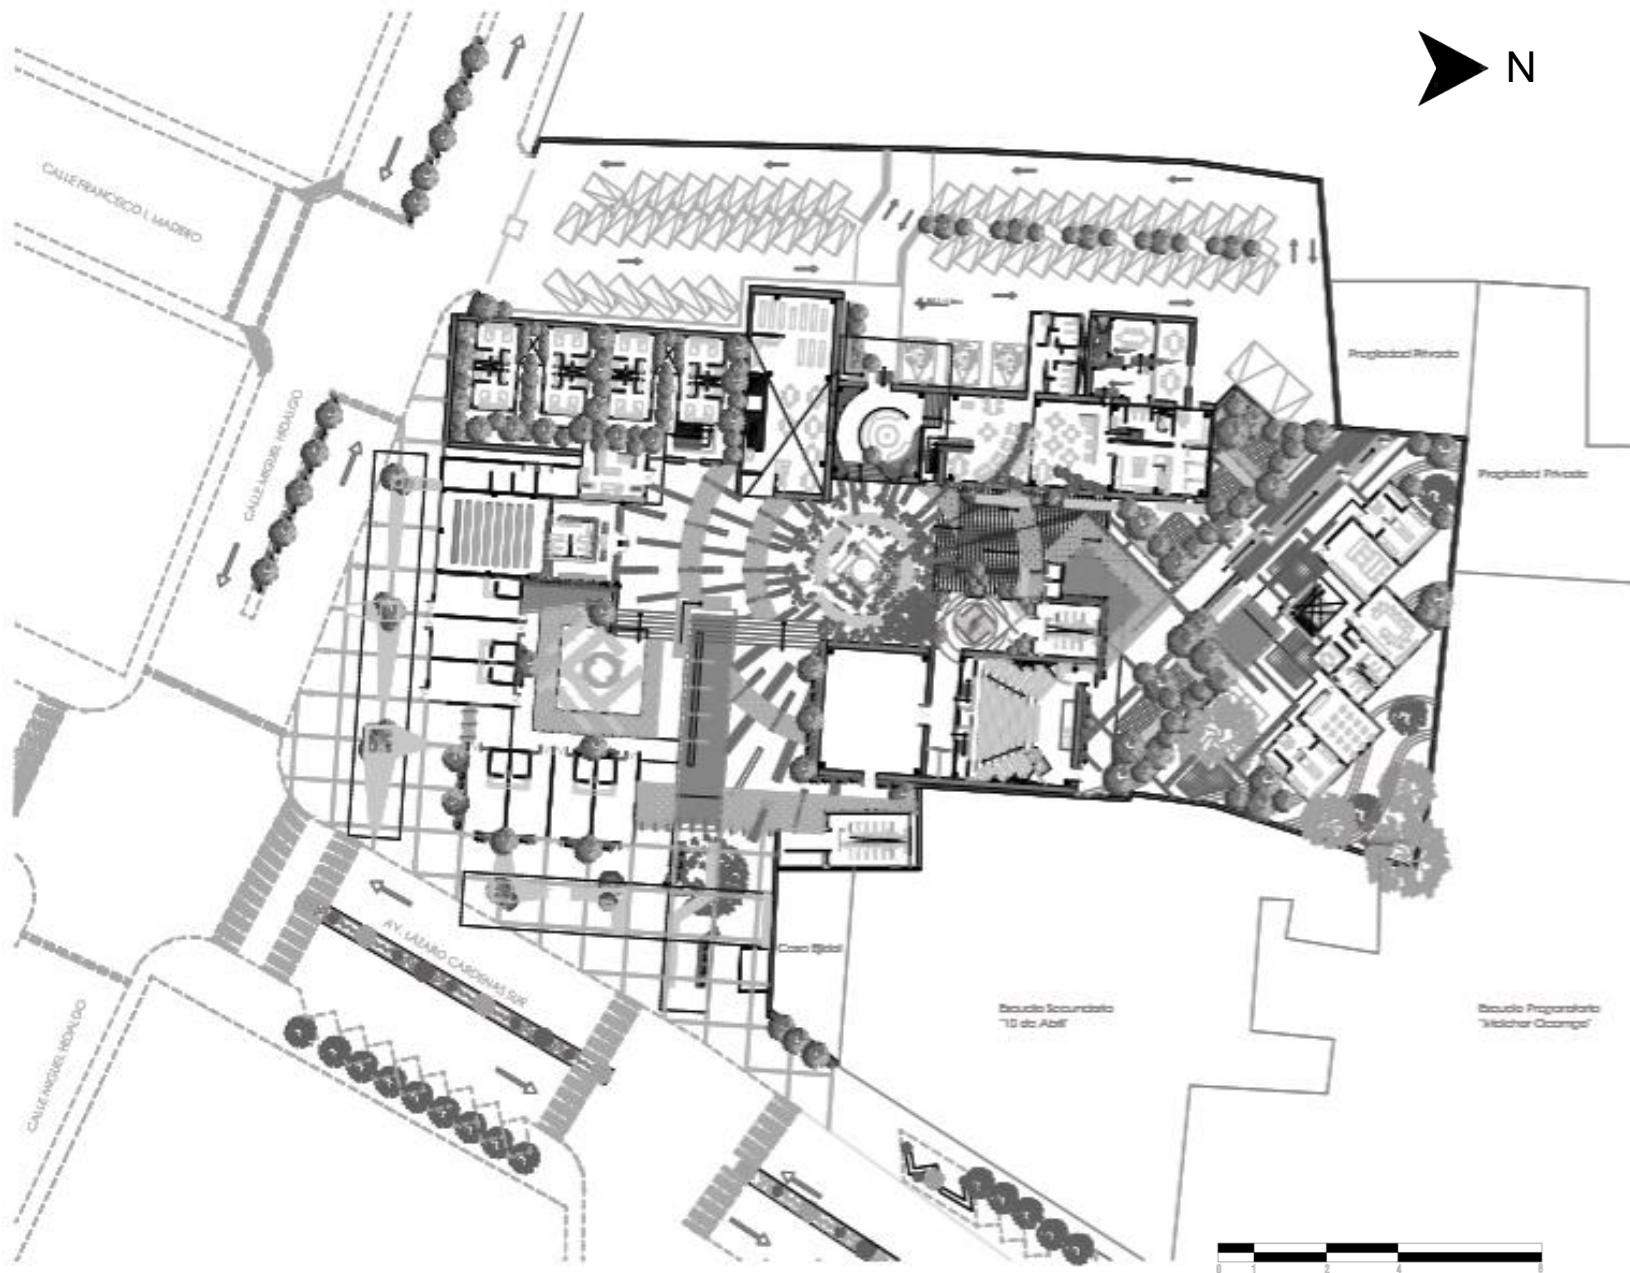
Planta arquitectónica de conjunto, Centro multidisciplinario Ex hacienda Cusi,
